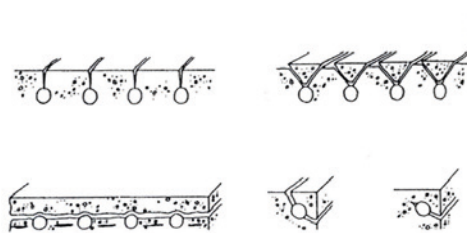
Formas de agrietamiento causadas por la expansión de las armaduras originada por su oxidación.
